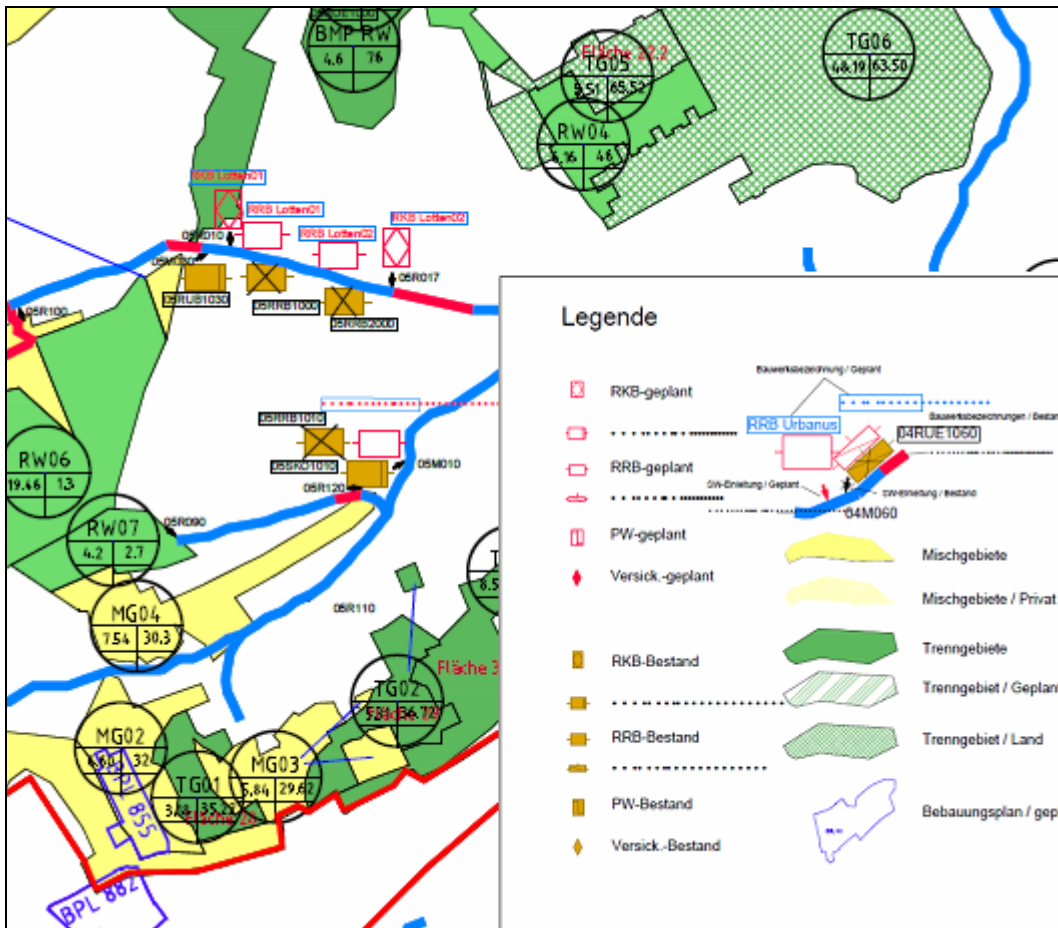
Ausschnitt eines Übersichtsplans mit entsprechender Legende
